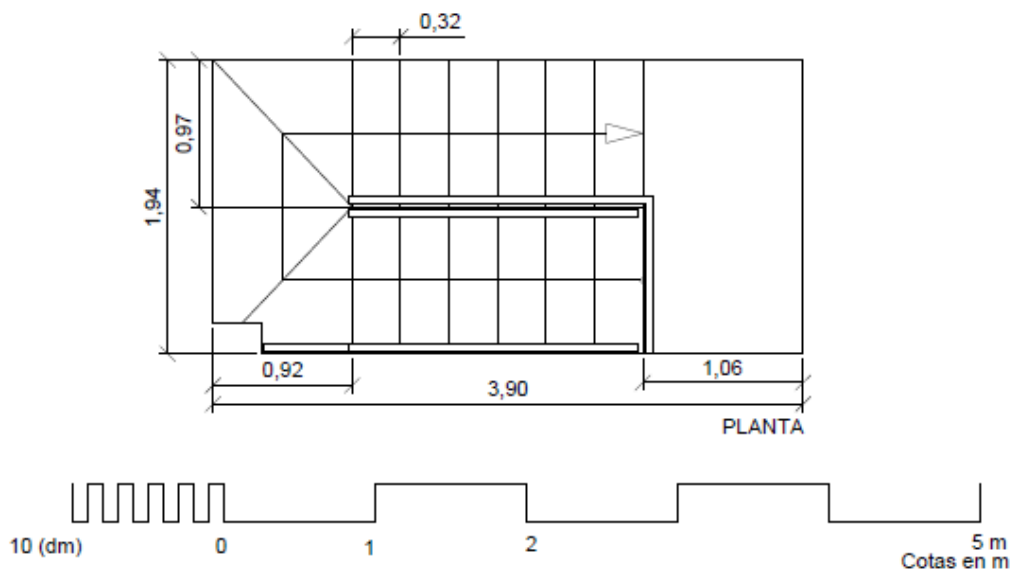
Planta con dimensiones de la escalera. Fuente: Elaboración propia
